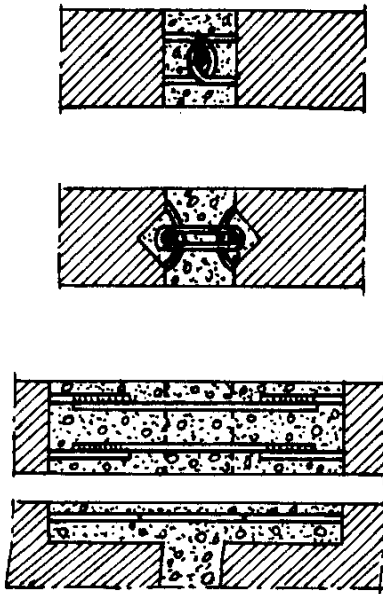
Juntas verticales de paneles interiores. Sección horizontal.
